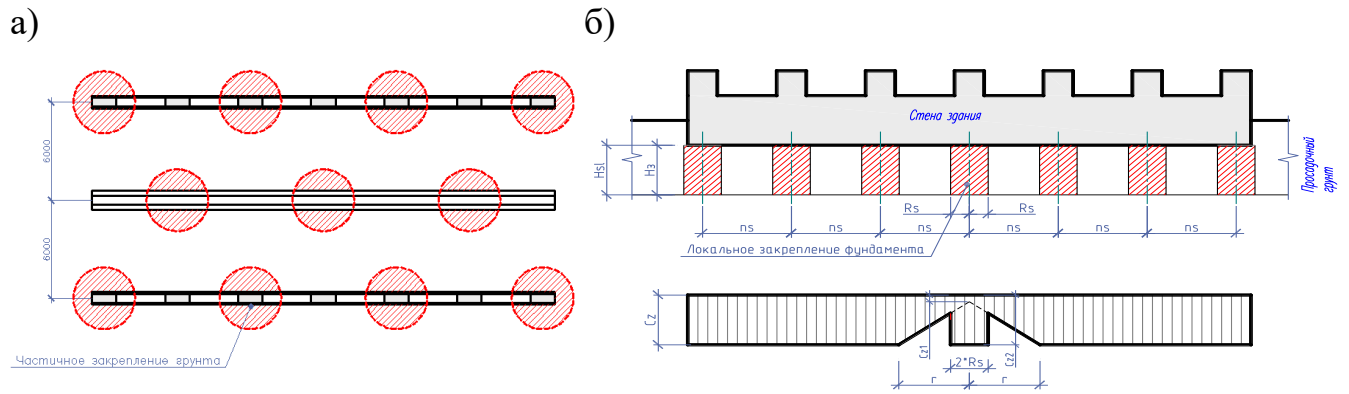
Расчетная схема частичного (прерывистого) закрепления просадочного грунта на фрагменте здания: а – в плане; б – в разрезе.
